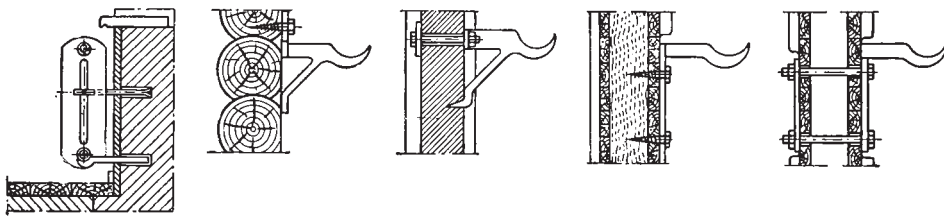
Кронштейны для радиаторов (последовательно слева направо): для установки на каменной стене; на бревенчатой стене; на стене из штукатурки и других подобных материалов; на внутренней перегородке; в полую часть внутренней перегородки.
